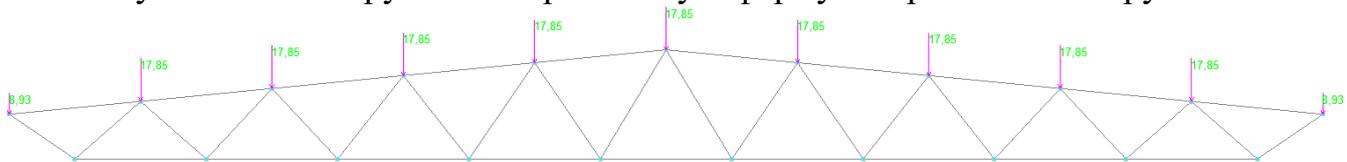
Нагрузки на стропильную ферму от веса покрытия
